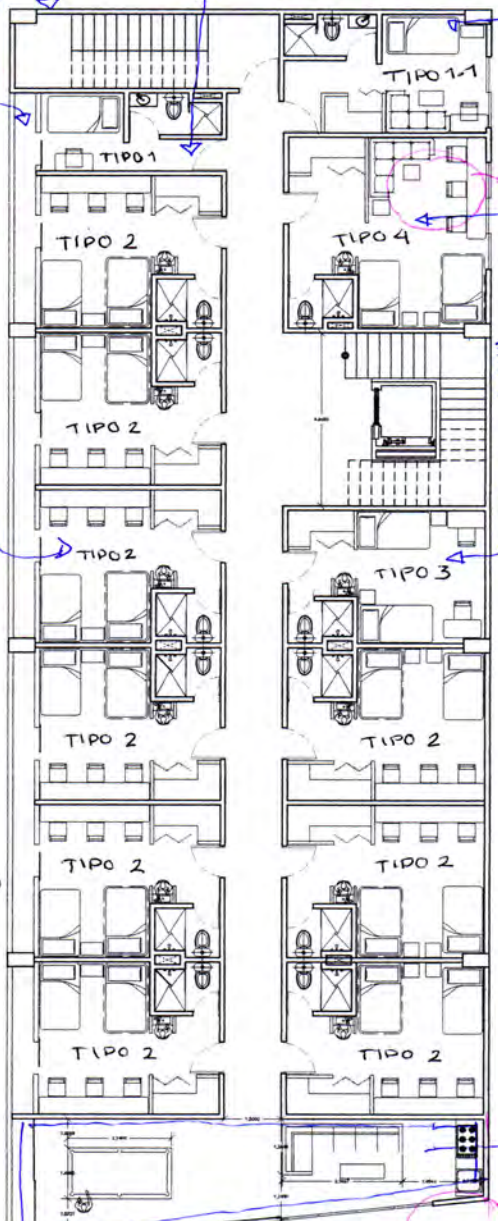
Primer acercamiento a la residencia Planta tipo creación propia 2022
